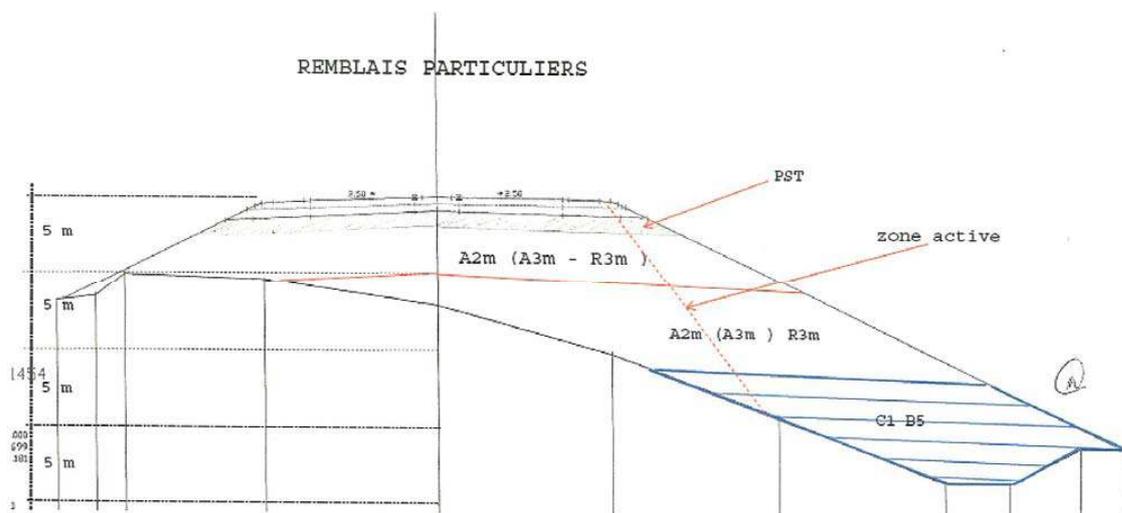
Schéma de montage d'un remblai sur versant [1]
